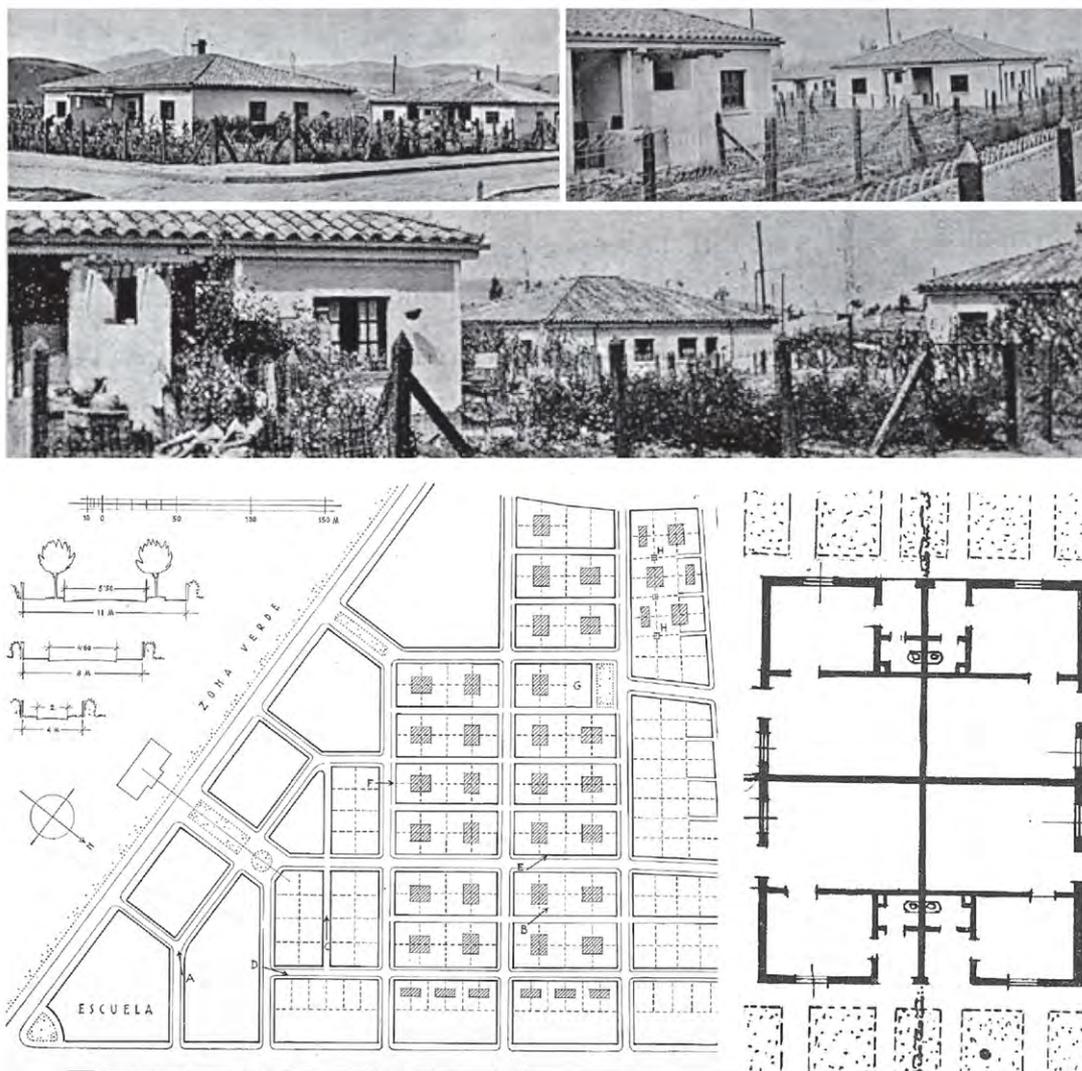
Fotografías, plano general y planta de casa tipo del barrio Centenario, en su primera etapa de construcción. Brunner, 1940, p.132 y 133.
